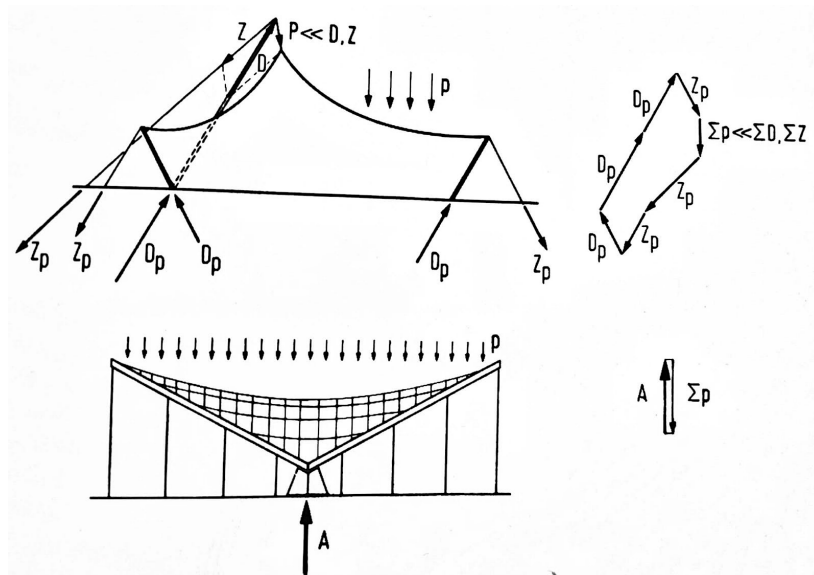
En las estructuras ancladas en la parte trasera las fuerzas de anclaje superan con creces las cargas
